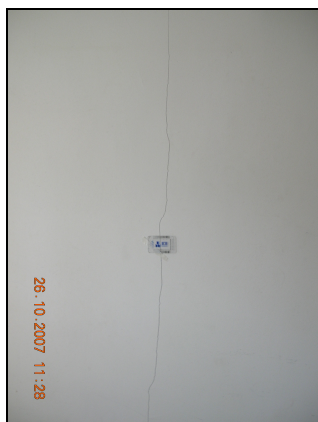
Fisuras verticales en albañilería de HCA
